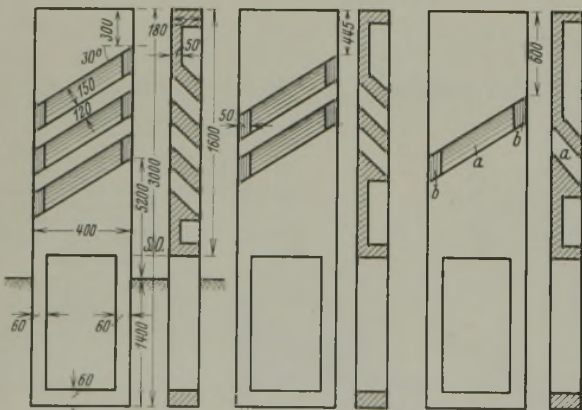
Baken vor Vorsignalen und vor Niveauebergängen von Eisenbahnen und Straßen aus Eisenbeton. D. R. G. M. 1 009 338.
